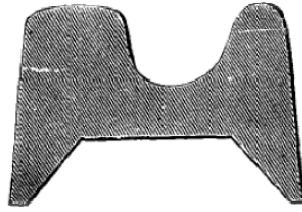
Section du Rail Loubat 19 kg/ml ech.1/2
